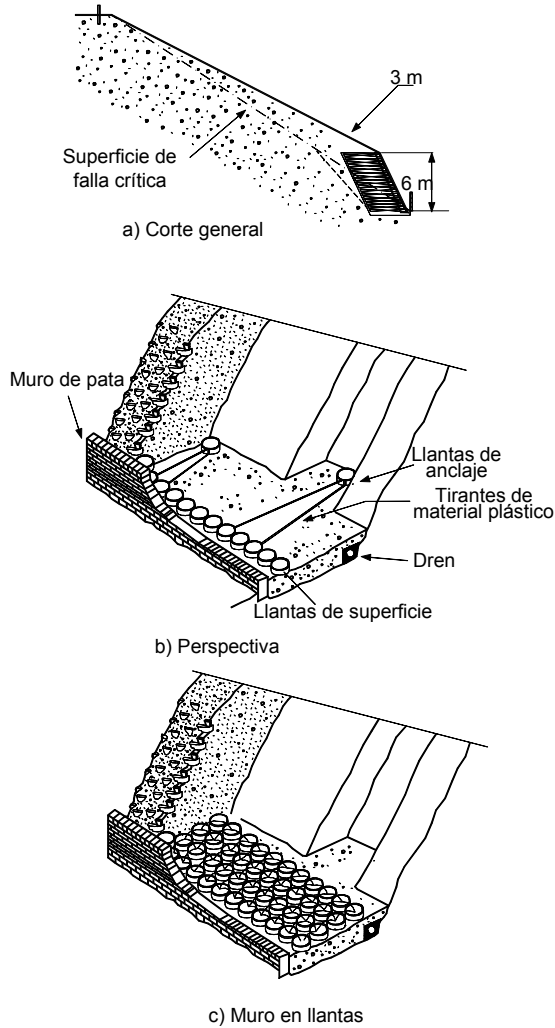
Muro con llantas usadas utilizando llantas con tirantes como elemento de anclaje.
